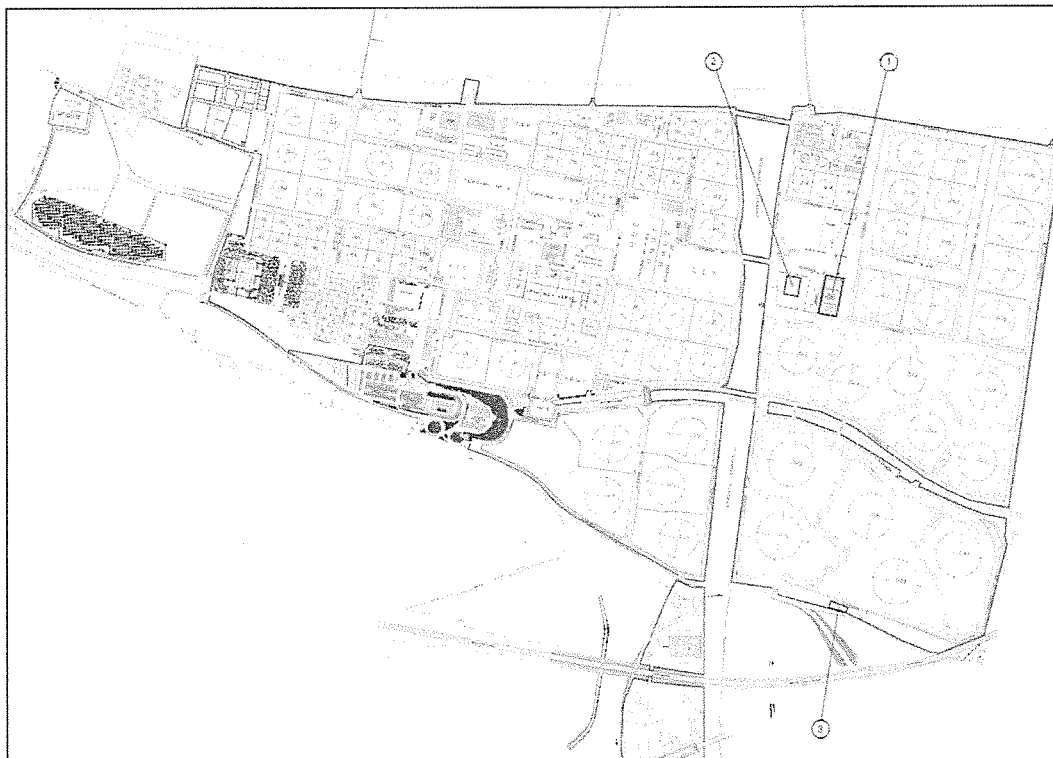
Disposizione aree di deposito rifiuti - nuovo assetto
